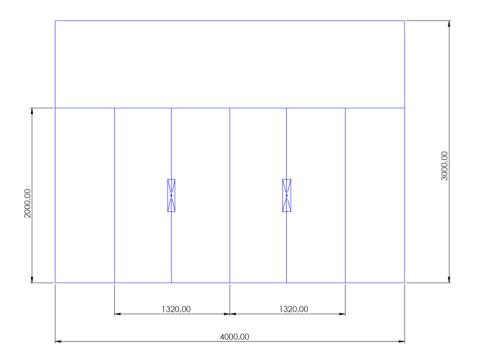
Vista frontal puertas de acceso a cámara de secado tipo, dimensiones en mm
